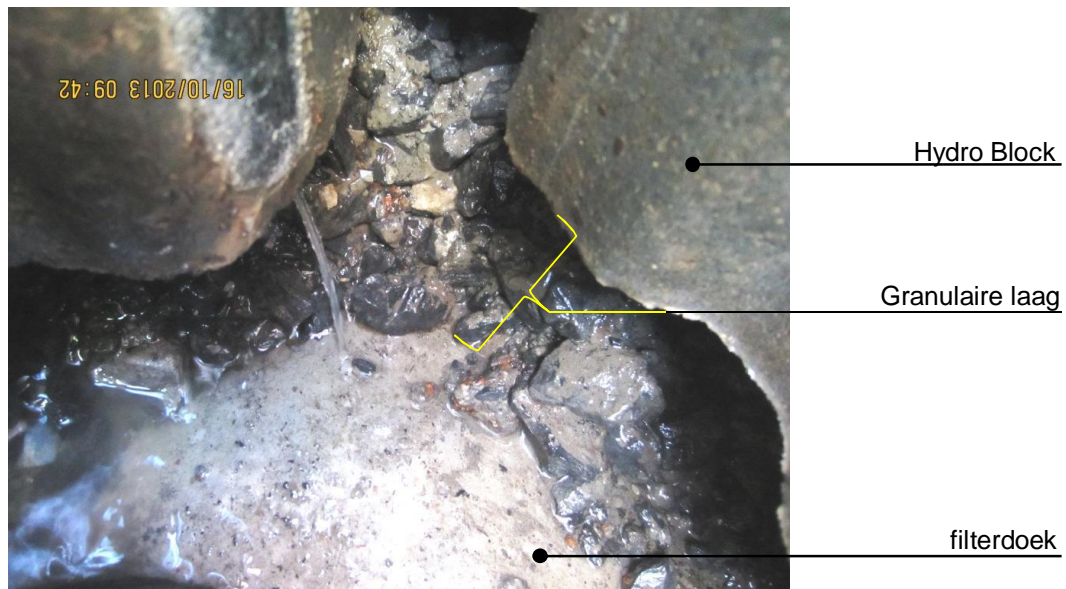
Foto genomen vanuit het boorgat in de verkitte slak
